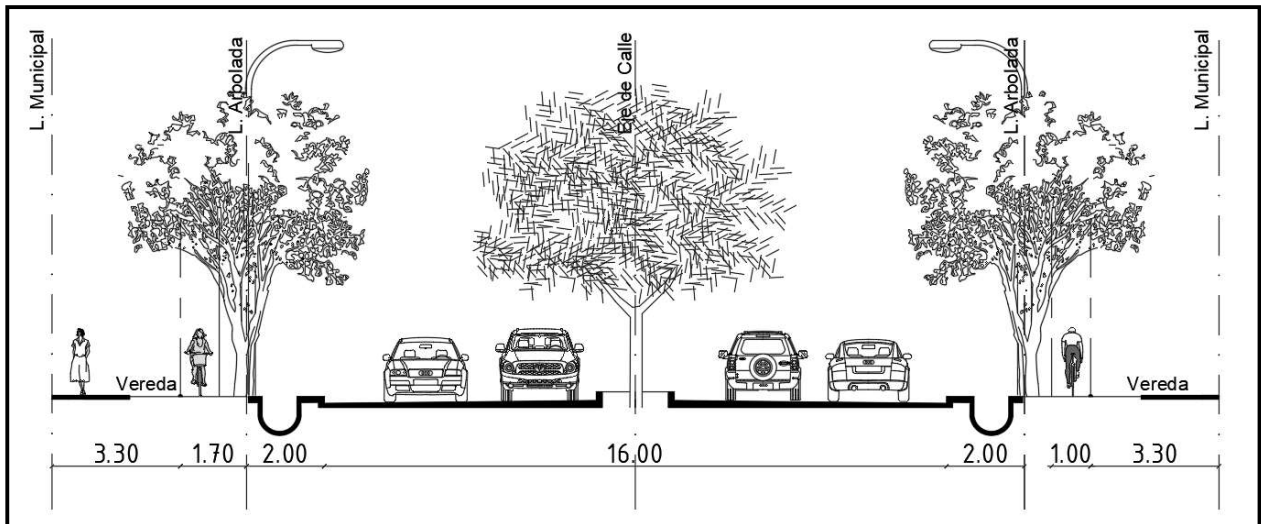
Perfil transversal en Av. Rivadavia, sector con boulevard
